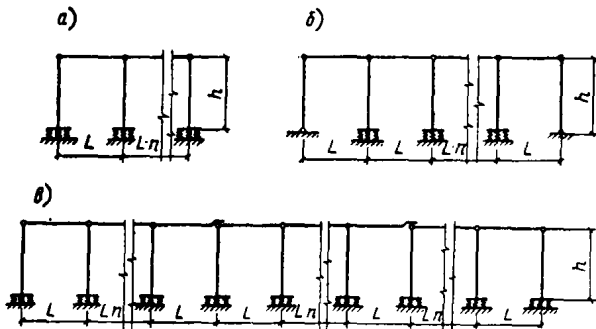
Схемы поперечных рам одноэтажных каркасных зданий
